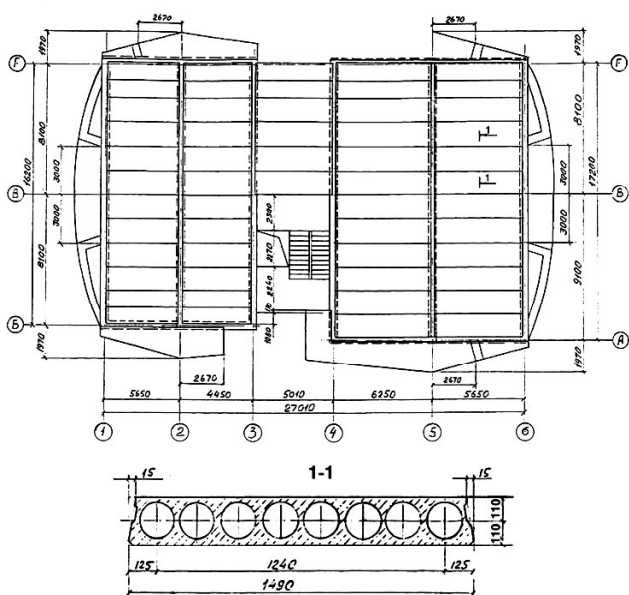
Сборное перекрытие из железобетонных многопустотных плит.
